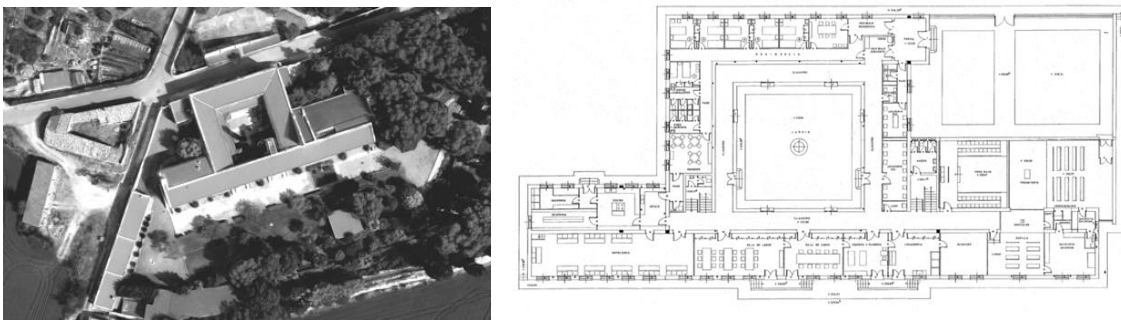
Ortofoto del estado actual y planta de proyecto del monasterio de las Benedictinas procedente del archivo municipal de Zaragoza.
